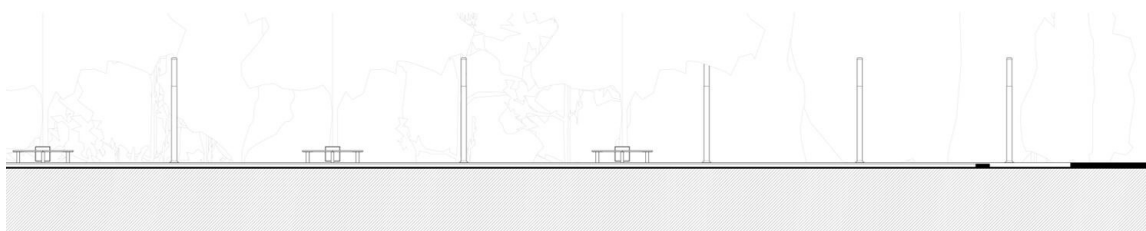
Elevación de primera parte de planta baja del corredor verde.
